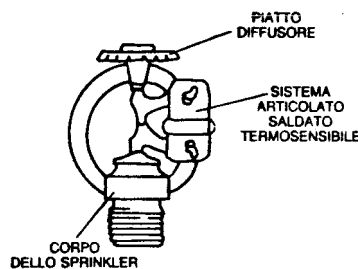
Erogatore (sprinkler) a fusibile assemblato
